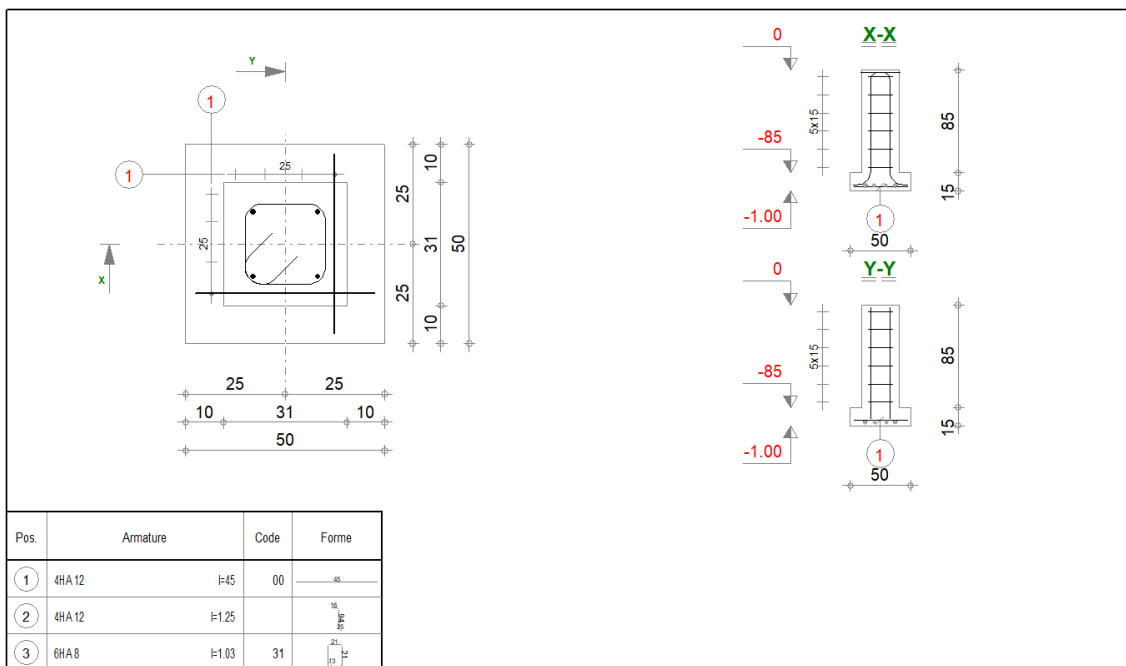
Ferrailage de la fondation du potelet et ces dimensions
